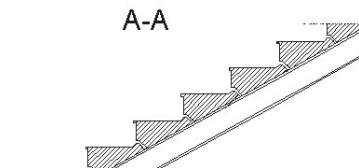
Scari cu structura mixta – detalii constructive
